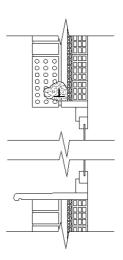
Encuentro de fachada caravista con ventana. Fuente: Edición propia
